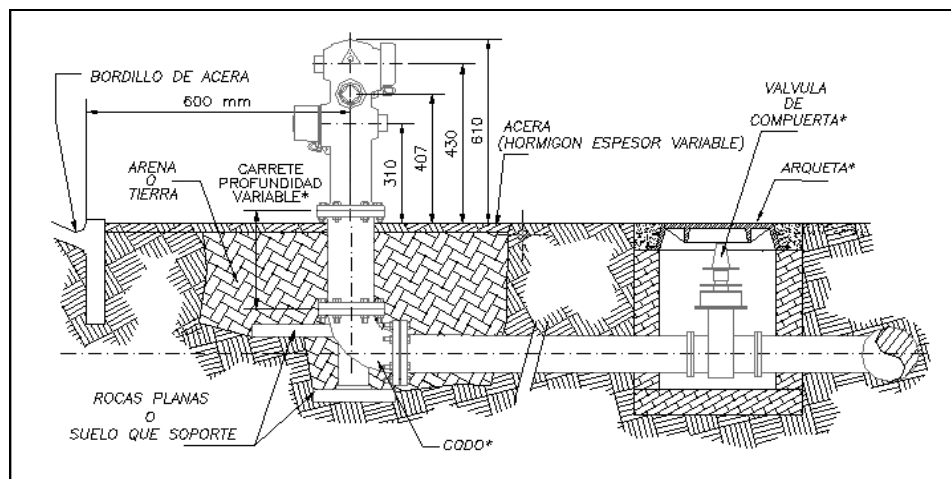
Esquema de instalación de hidrante columna exterior (CHE)
